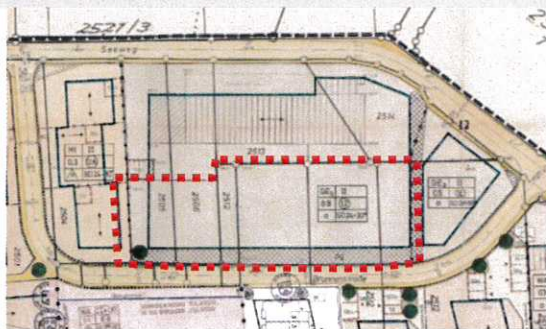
Bebauungsplan „Obere Matten II“ mit Änderungsbereich der zeichnerischen Festsetzungen
